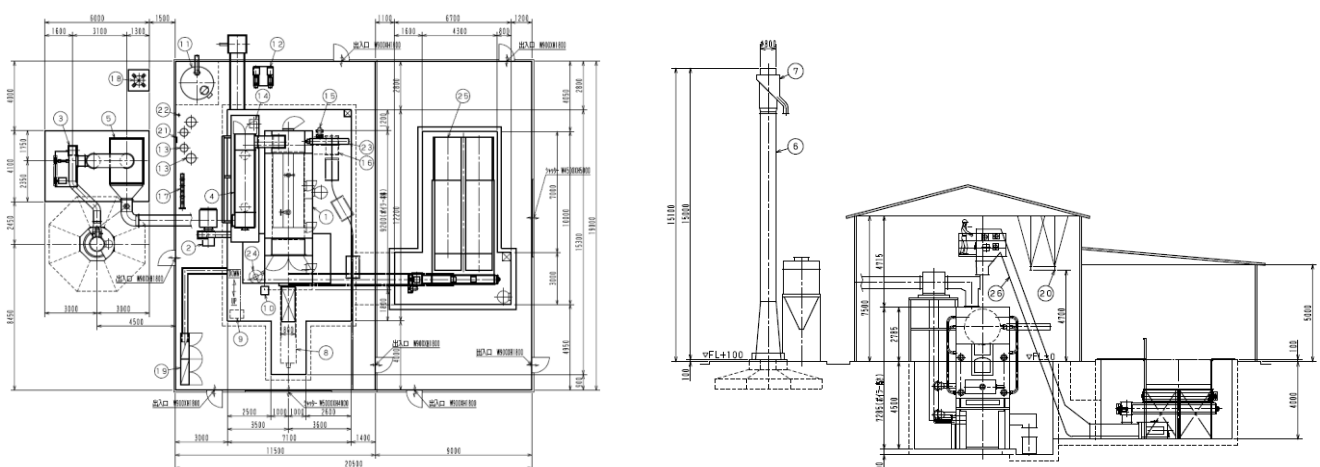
チップ焚き蒸気ボイラーの平面図と立面図
